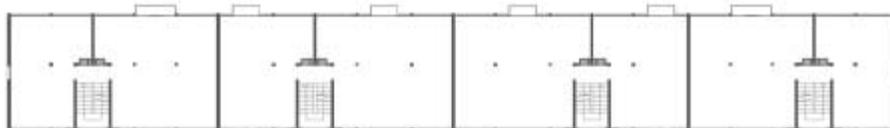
Planta típica de Weissenhofsiedlung, Stuttgart (1927), diseñada por Mies van der Rohe. (Till y Schneider, 2005)
